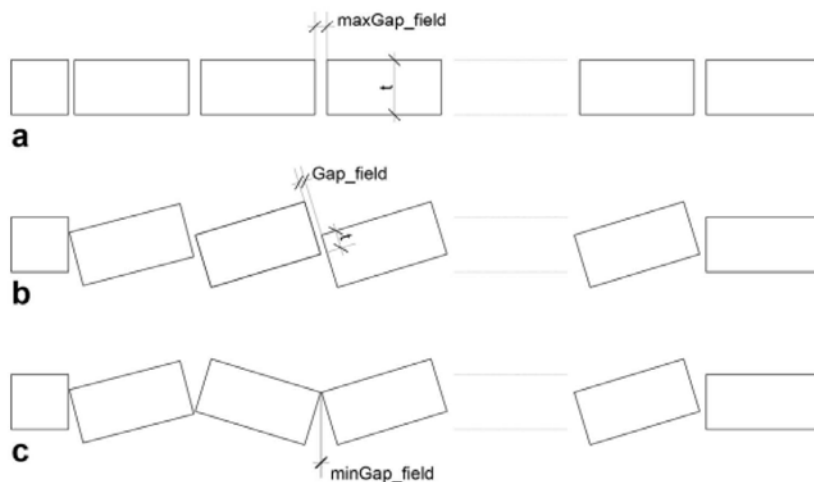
Disposição dos tijolos sobre viga de concreto. Fonte: Archdaily.
